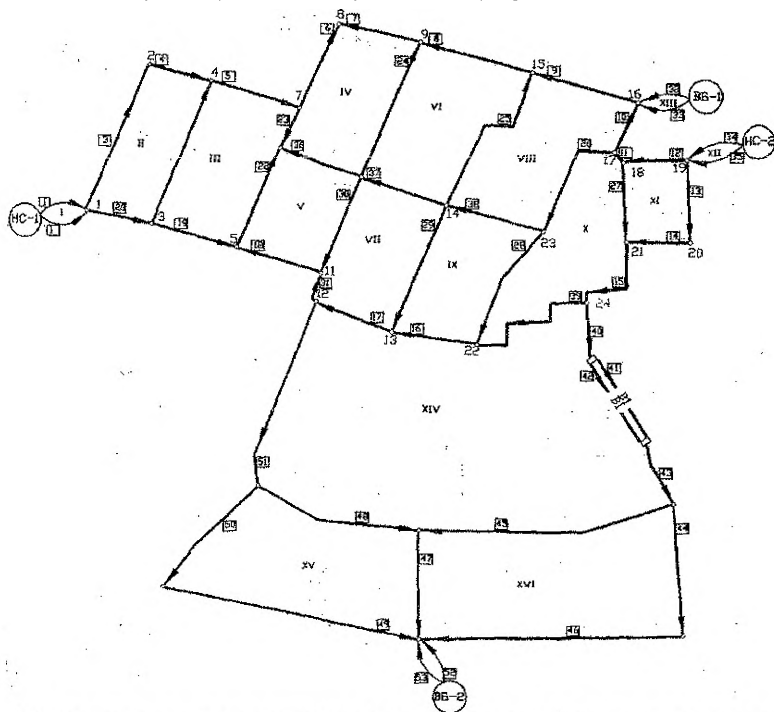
Расчетная схема водопроводной сети с учетом второй очереди строительства.
